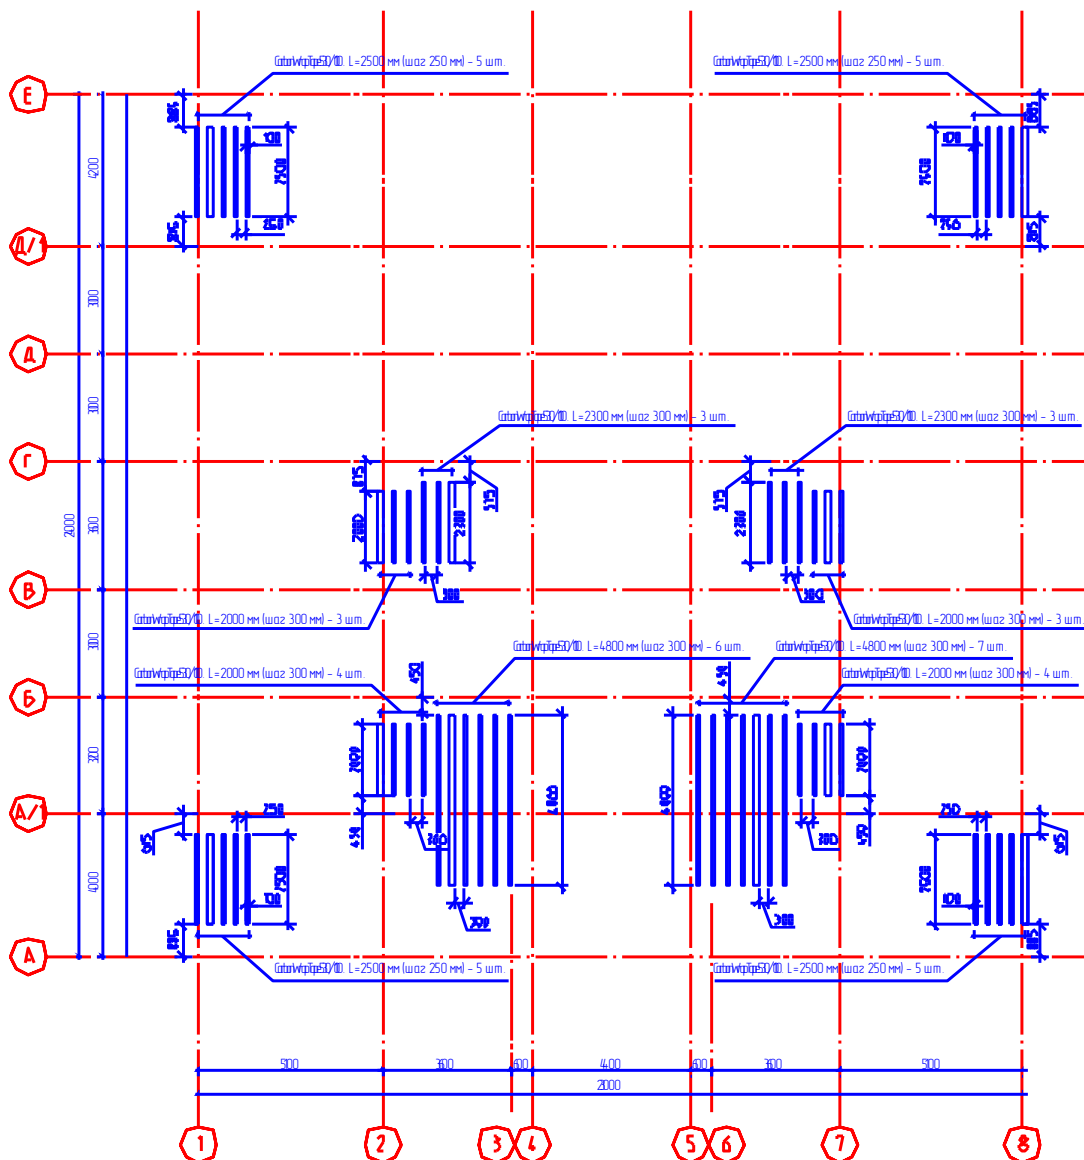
Схема усиления плит перекрытий ламелями на основе углеволокна
